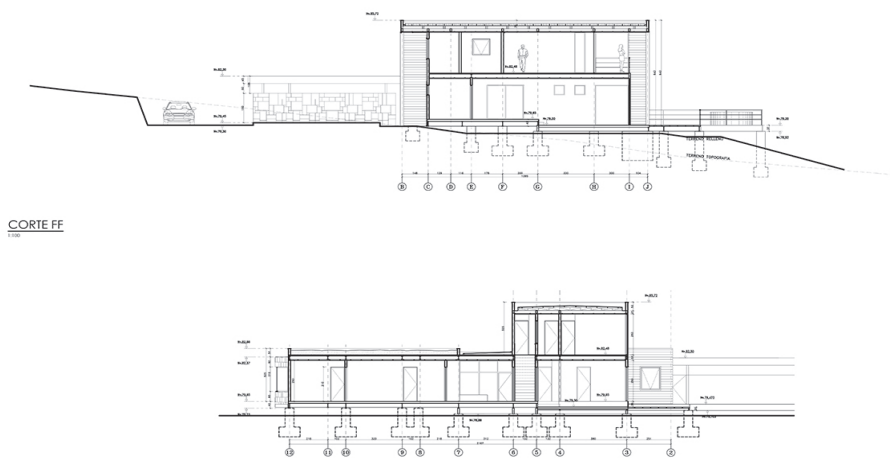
Sección de la vivienda que muestra la pendiente y las múltiples zapatas bajo la estructura.
